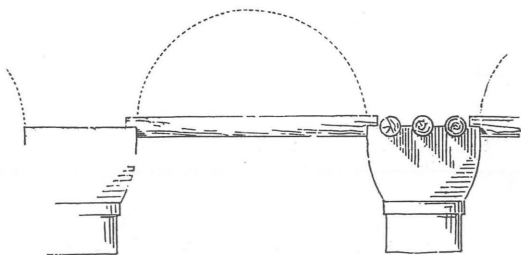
Cadenas de arriostramiento horizontal en cabeza de las columnas (cisterna de las Mil y Una Columnas)
